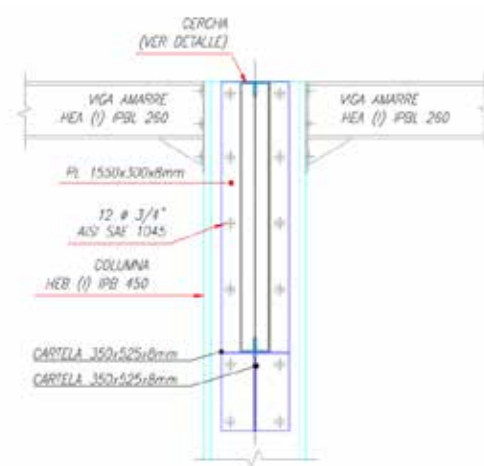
Detalle de Viga de Carga con Columna HEB 450 Apernada. (2016).
